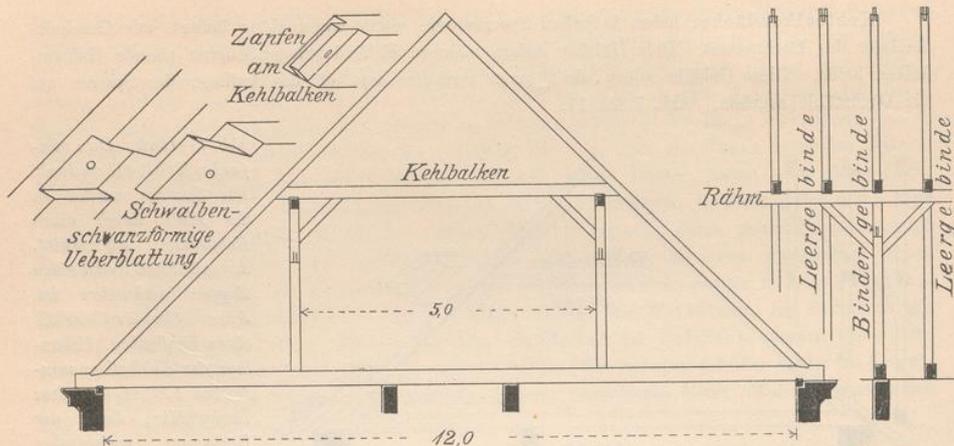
Dach. Kehlbalkendach mit doppeltem stehenden Stuhle.
